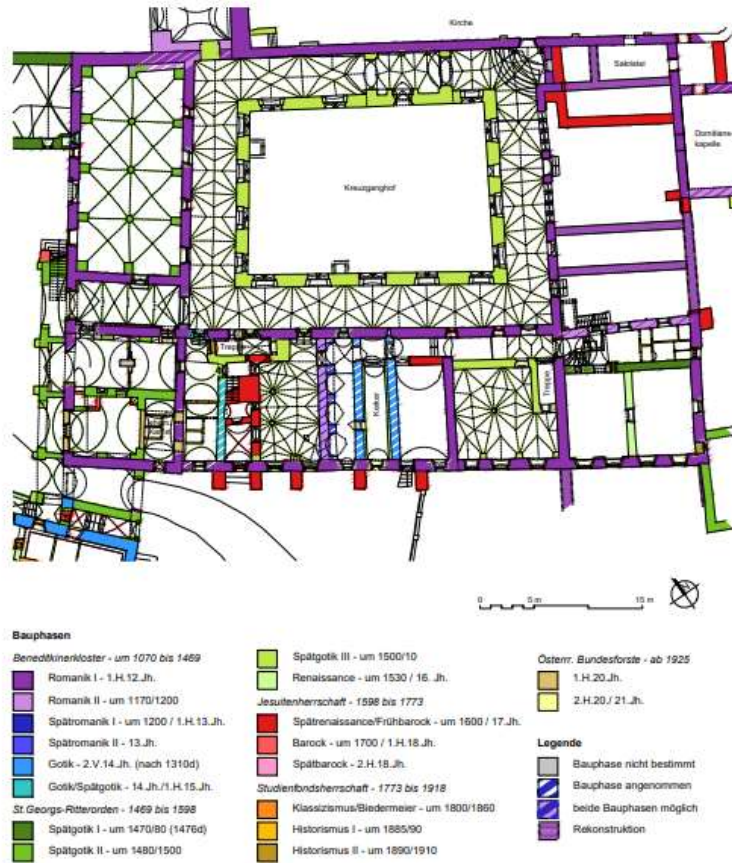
Baualtersplan des Klostergevierts, Grundriss des Erdgeschoßes. (© Wolfgang/Fries/Kuttig, Plangrundlage: EKG Baukultur, Wien)
